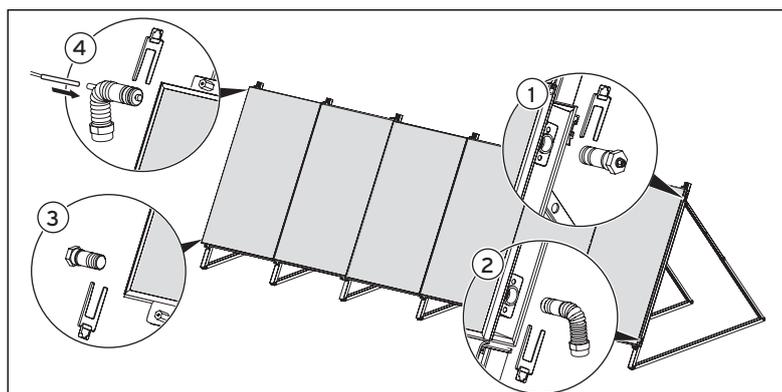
Montaggio dei collegamenti idraulici (6 o più collettori)
